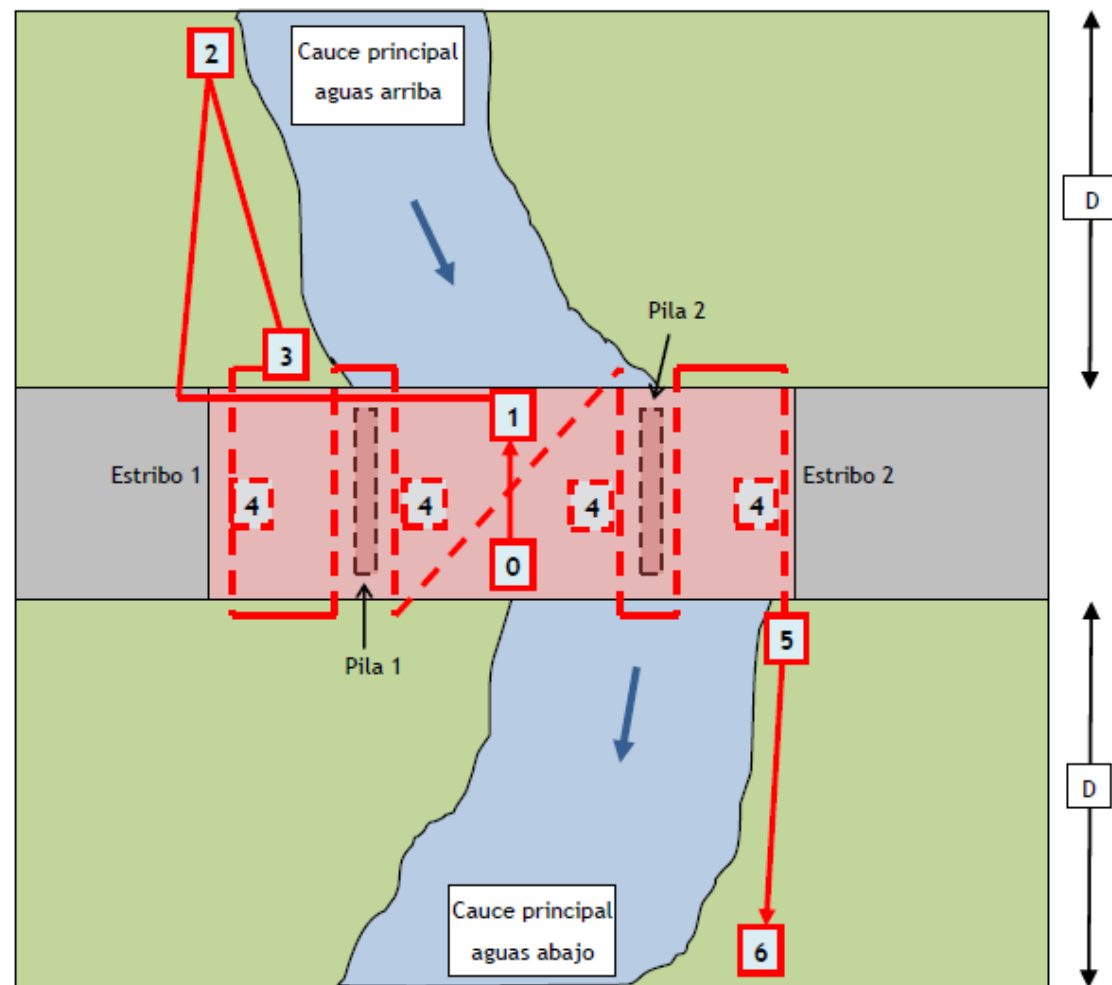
Recorrido para inspección del cauce (Fuente: Manual de Inspección Principal de Cauces)
